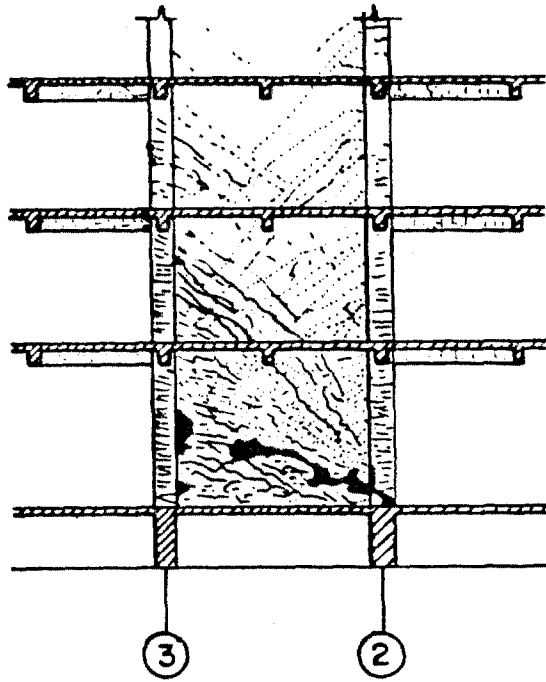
Fissuração do modelo parede-pórtico
